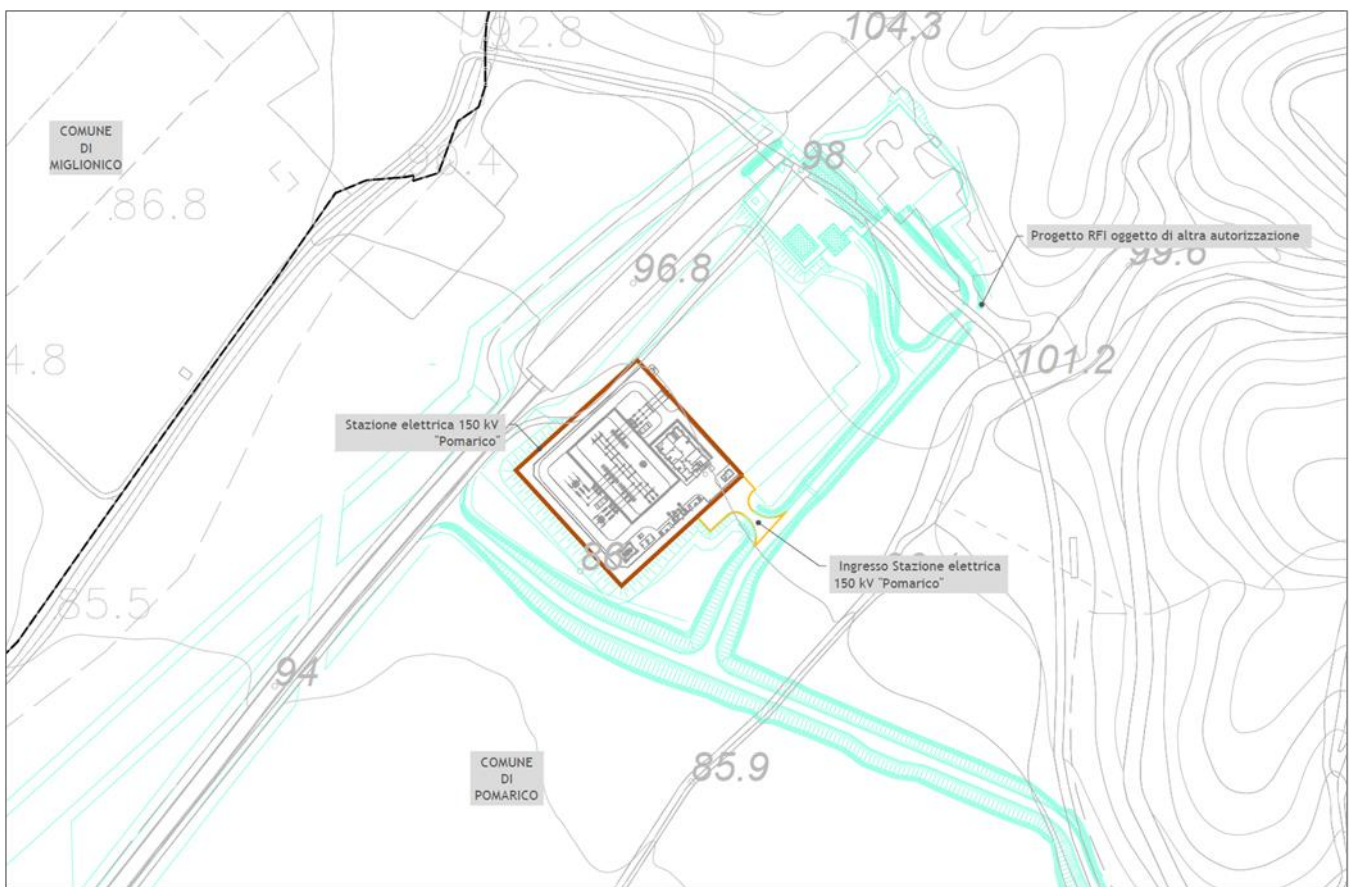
Planimetria di inquadramento della Stazione elettrica (perimetro rosso), ricompresa all’interno del perimetro del progetto di RFI (in celeste)
